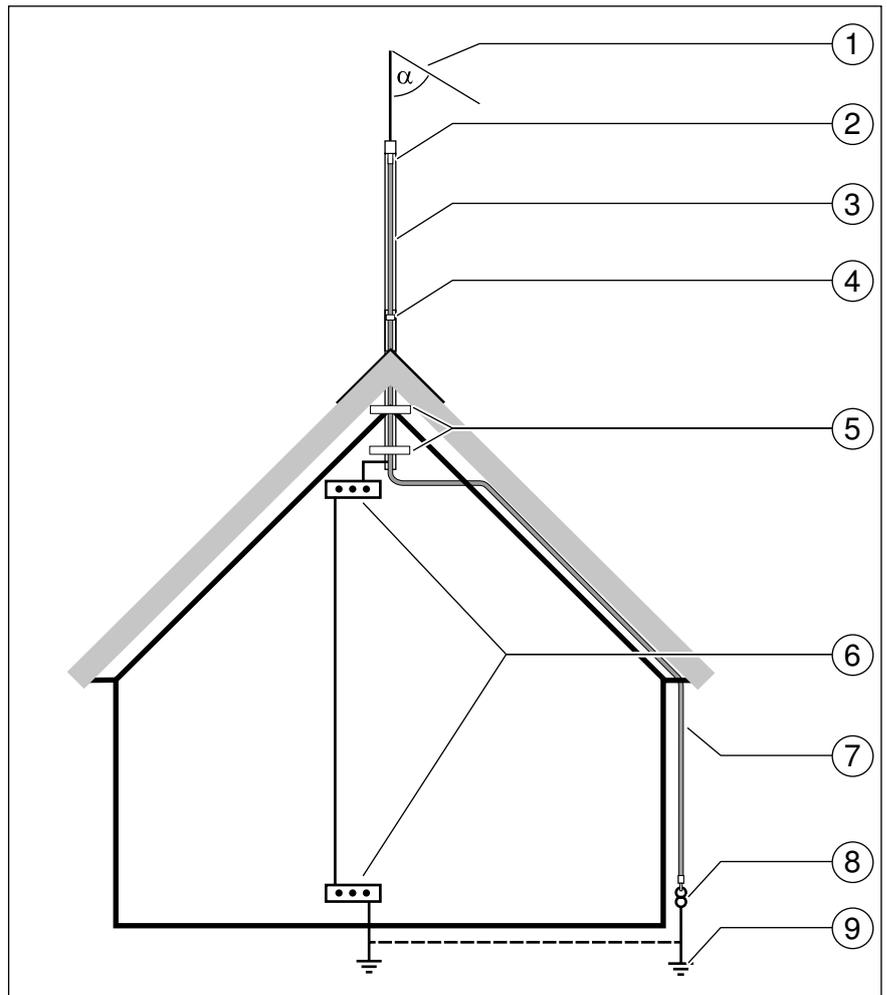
Installationsbeispiel: weichgedecktes Dach
